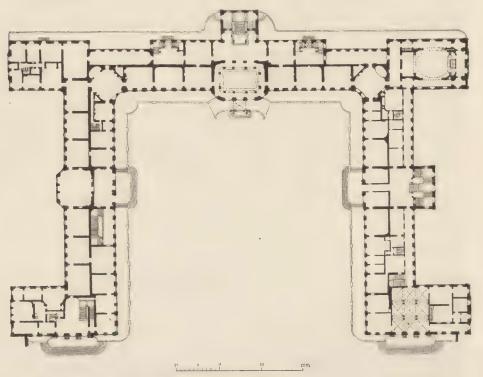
Refidenzschloss zu Stuttgart. Grundriss.
